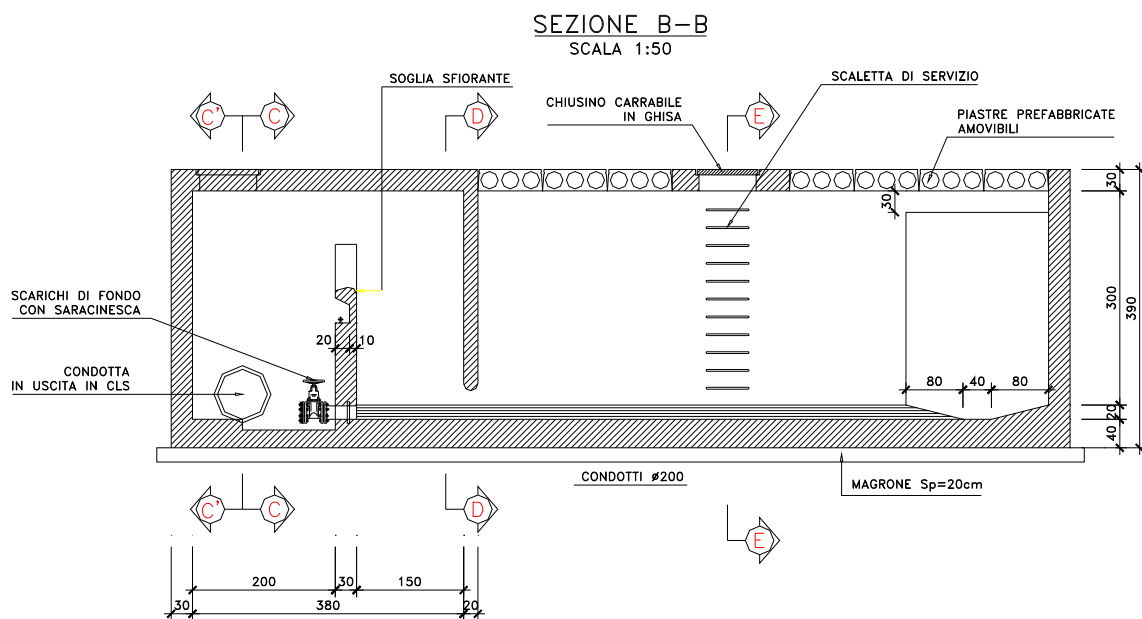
Vasca di trattamento delle acque di piattaforma – sezione longitudinale B-B
